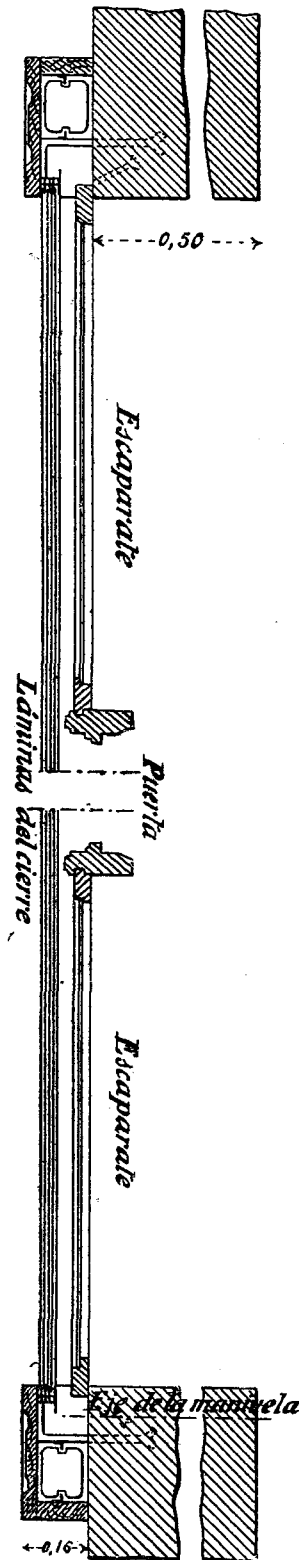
Cierre sistema Chédeville: sección horizontal.
